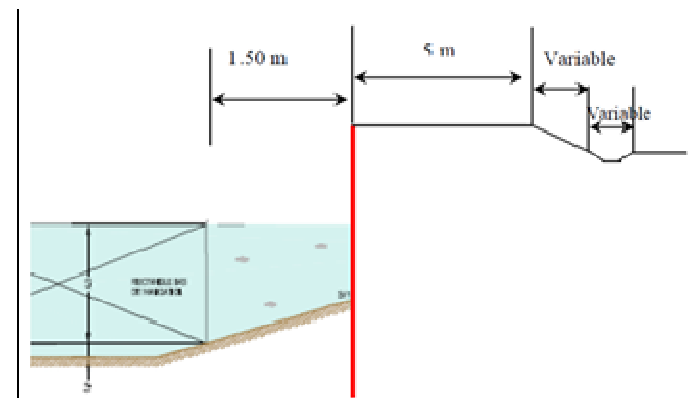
Schéma de principe d'un profil raidi à rideau de palplanches
